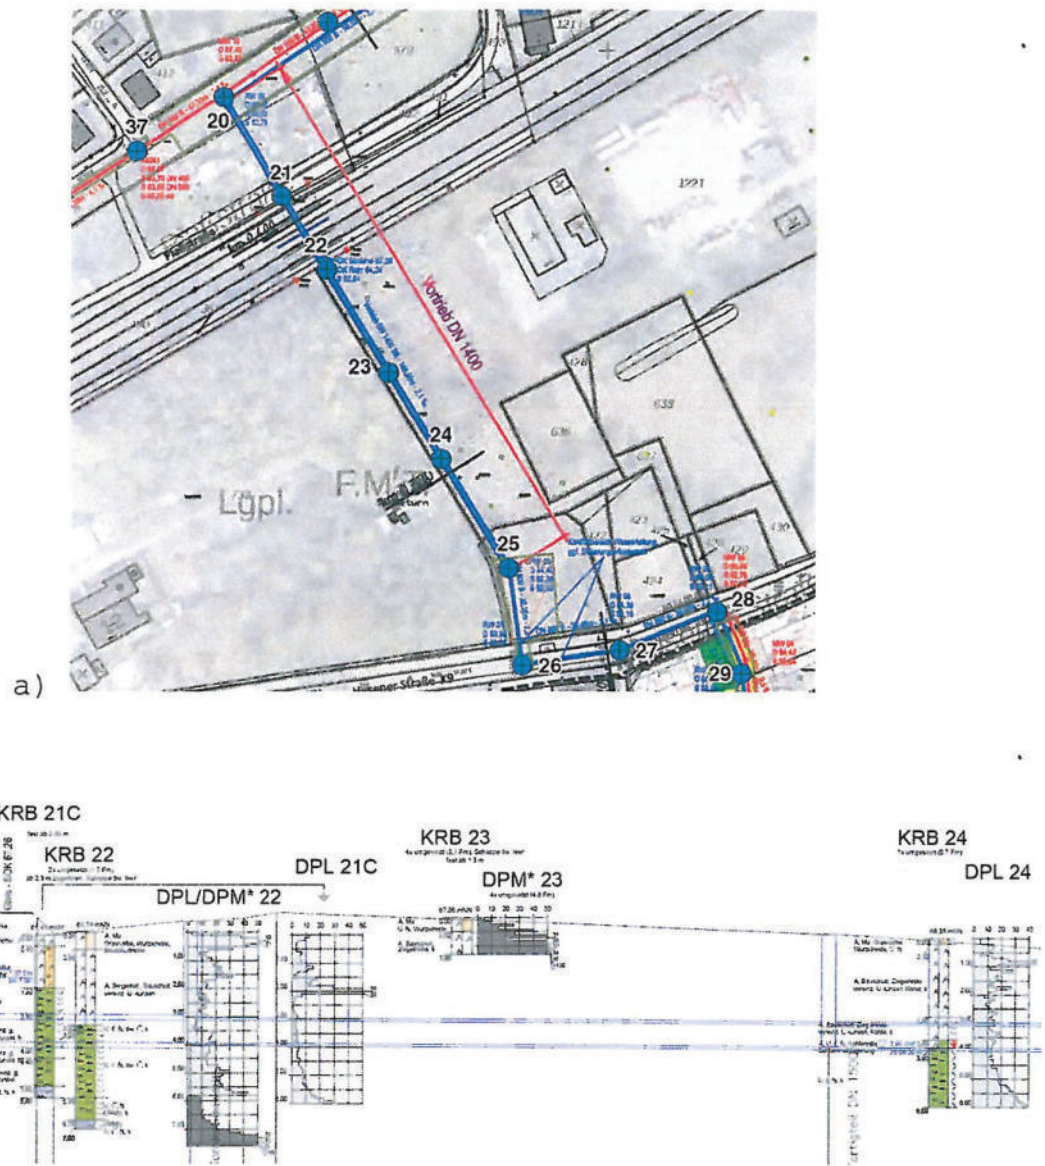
Ergebnisse der vorhandenen Baugrunderkundung im Bereich II [U2]: a) Lageplanausschnitt, b) Schichtprofile und Rammdiagramme
